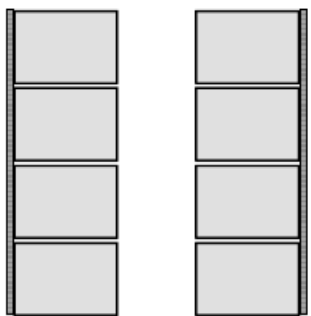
3: Grundrissformen zur Bestimmung der Höchstwerte für Fassaden nach Tabelle 10
